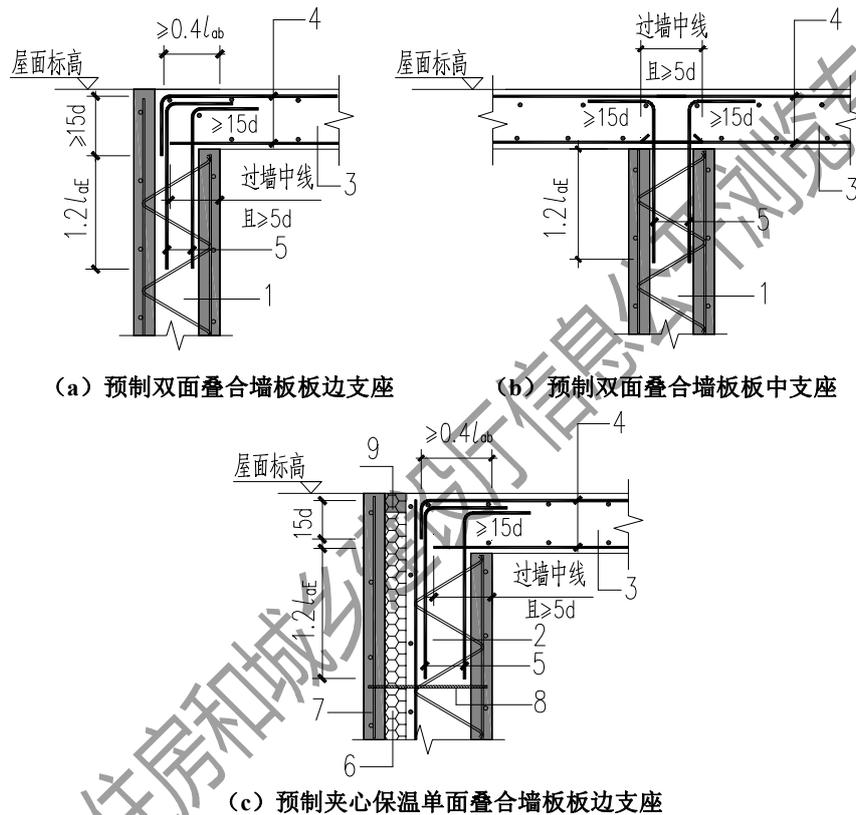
现浇屋面板与叠合剪力墙连接构造示意
